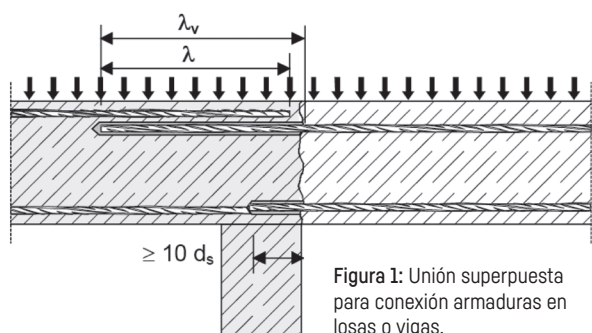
Unión superpuesta para conexión armaduras en losas o vigas.
